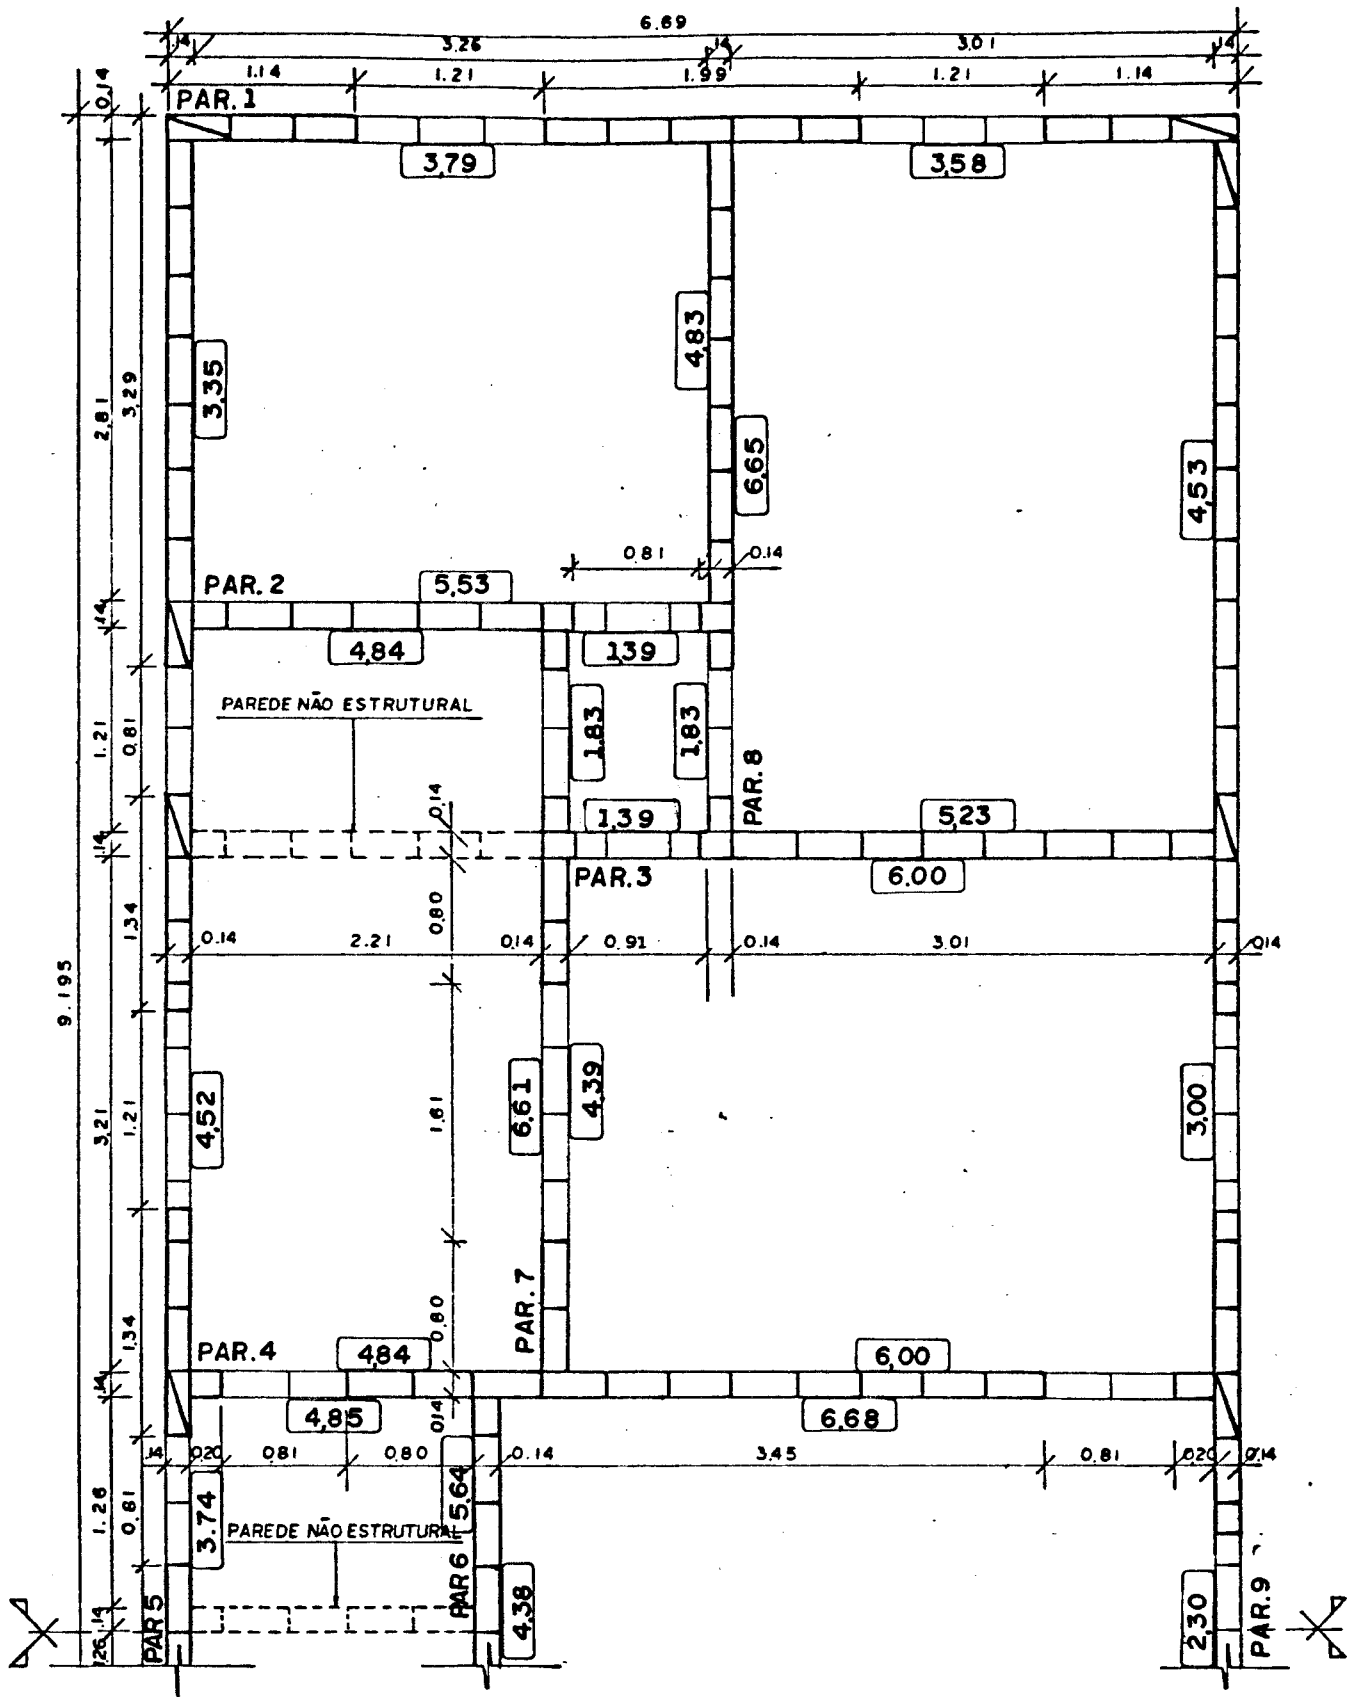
REAÇÕES DE APOIO DAS LAJES DO
